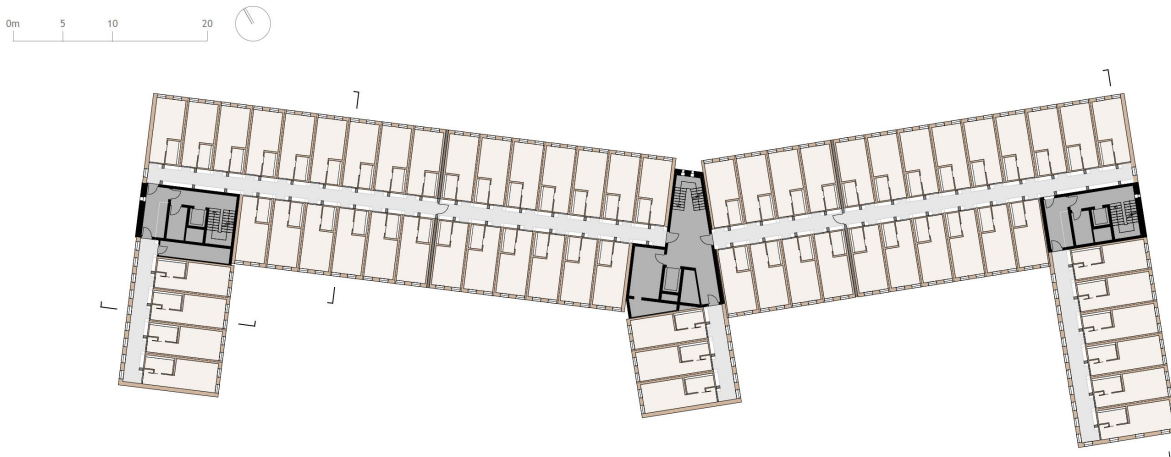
Grundriss eines Regelgeschoßes [9]
